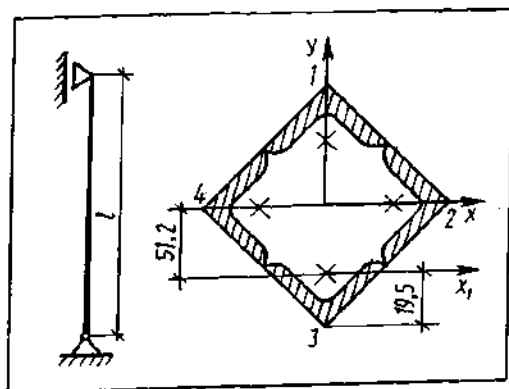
Расчетная схема и поперечное сечение стойки (пример 10.2)
